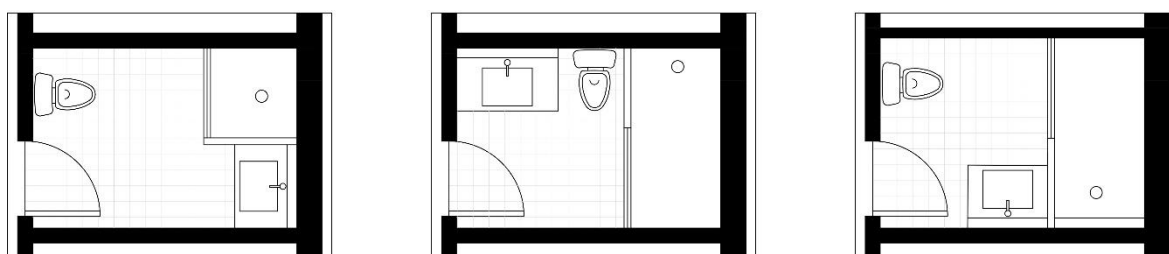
Pormenor de estudos de layout para casa de banho social.
